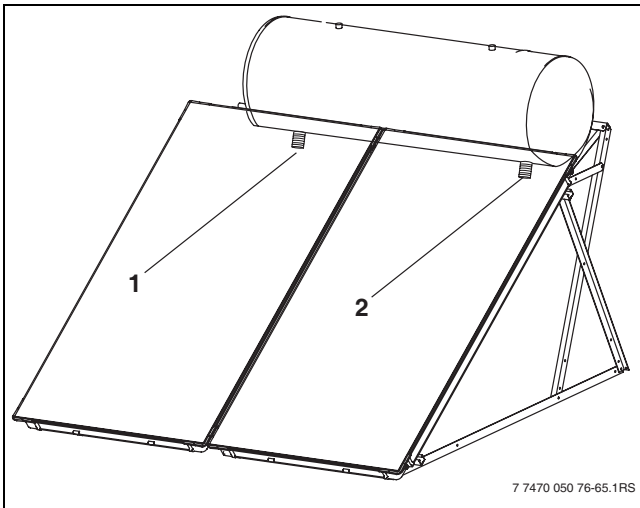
Raccordement des conduites d'eau chaude sanitaire
